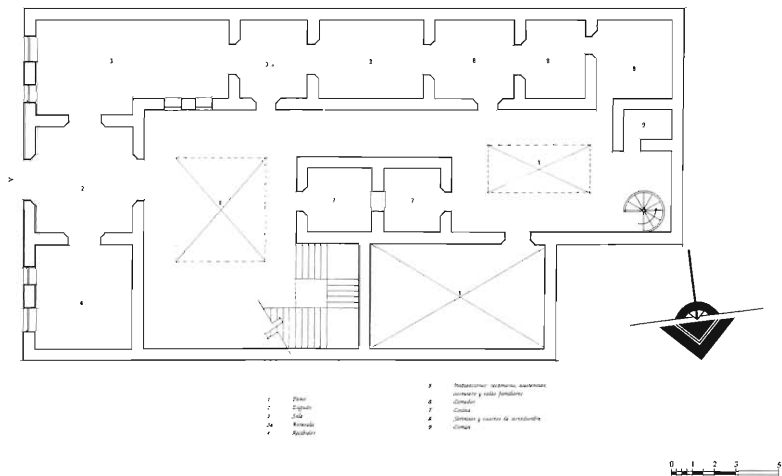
MACEDONIO ALCALÁ NÚM. 201. PLANTA BAJA.
